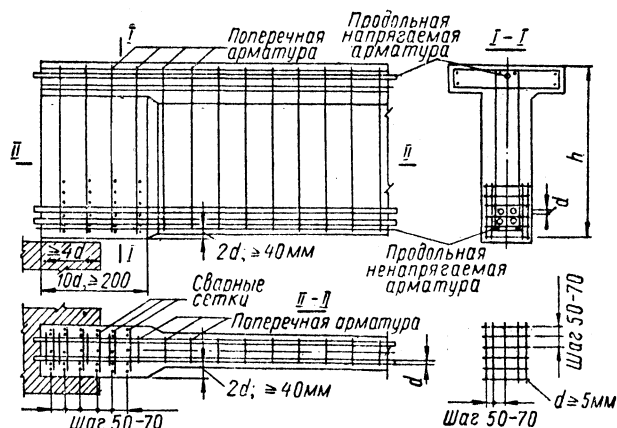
Усиление конца изгибаемого предварительно напряженного элемента с пучковой арматурой путем увеличения толщины защитного слоя под анкером и установки поперечных сварных сеток.
